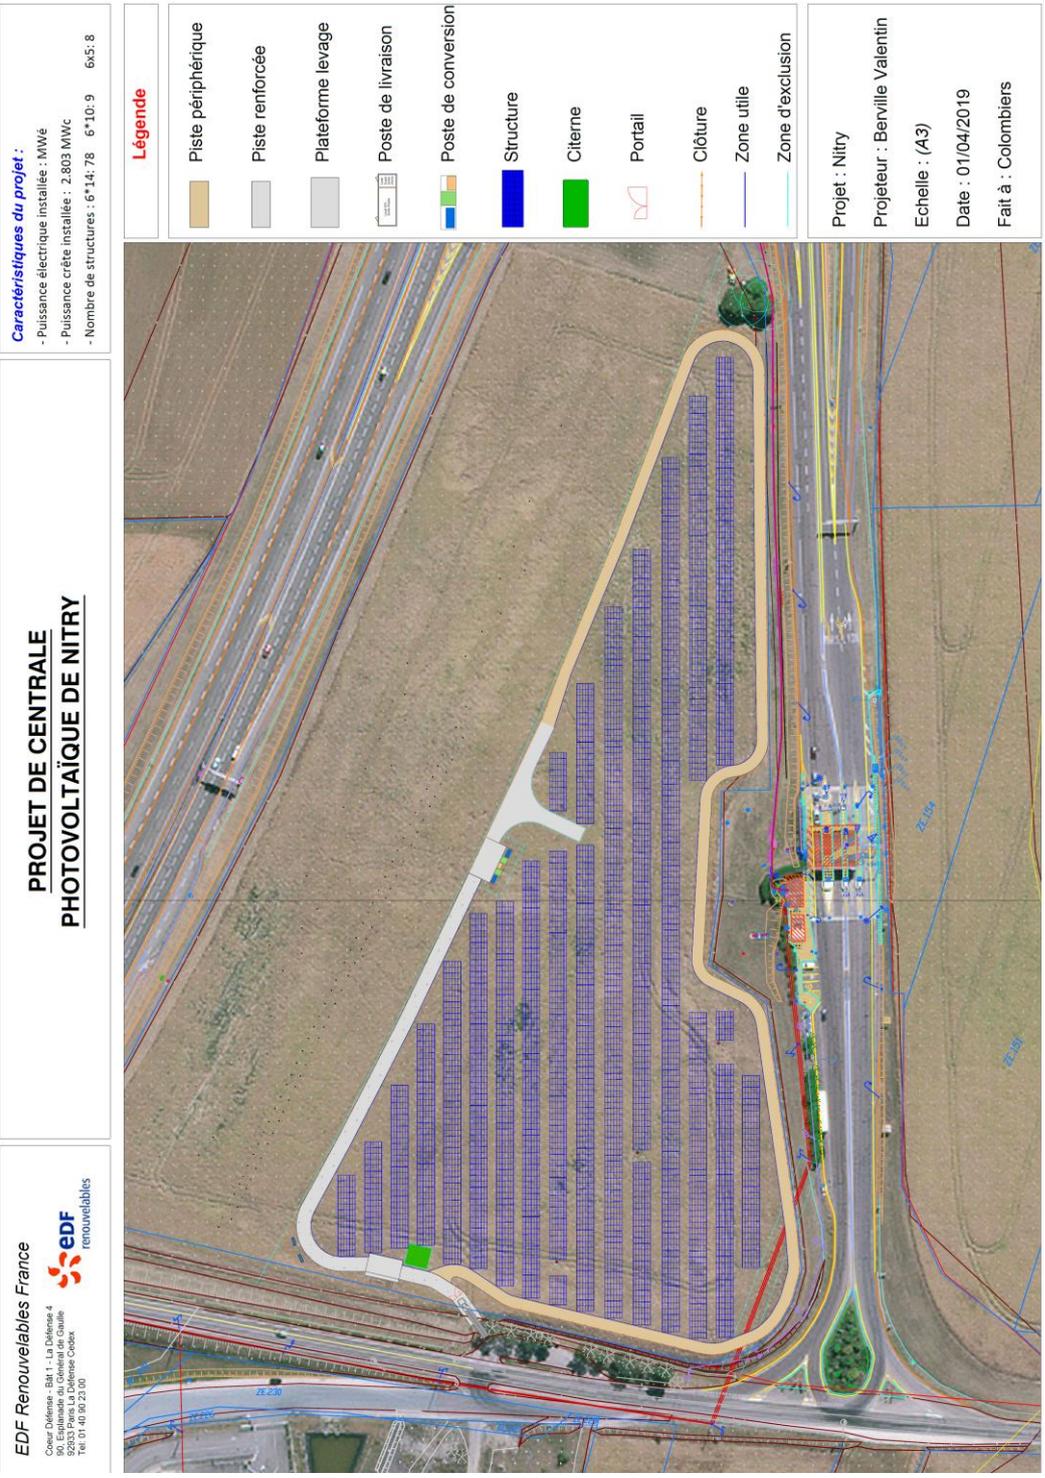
Plan masse du projet (Source : EDF-Renouvelables)
